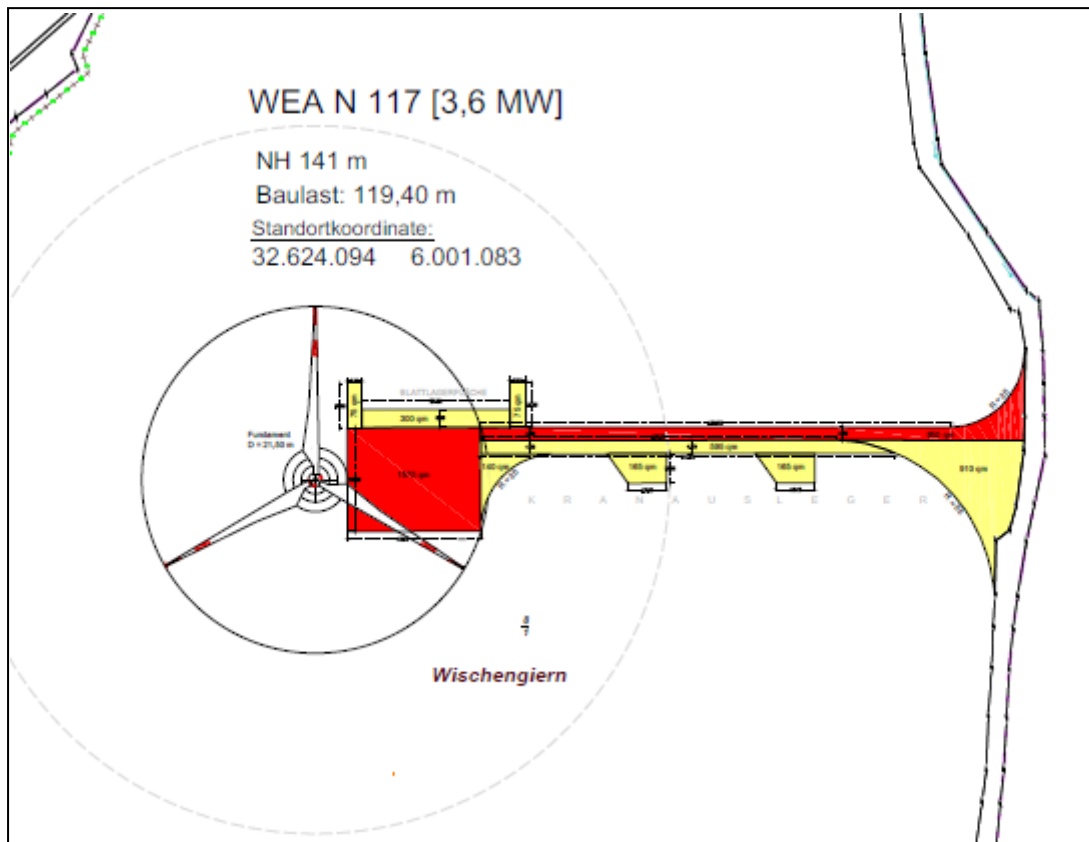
Lageplan mit Darstellung der antragsgegenständlichen Planung [unmaßstäblich verkleinert]
